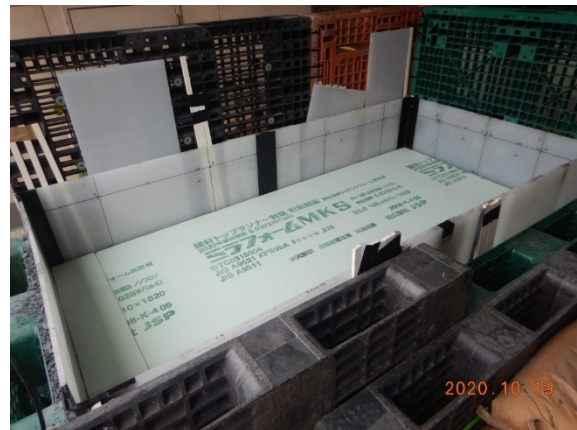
下層路盤 (建築用断熱材) 施工
